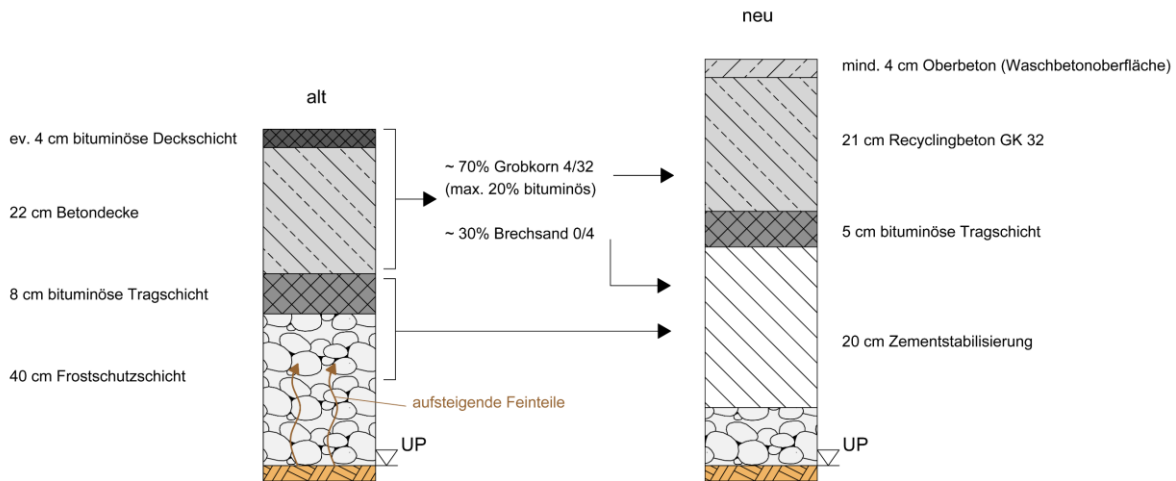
Bewährtes Recyclingkonzept im Betonstraßenbau [2]
